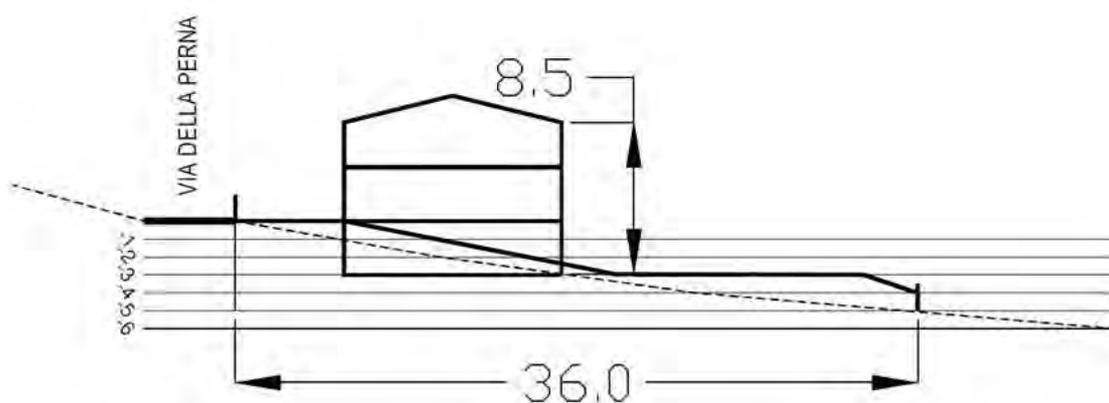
Sezione tipo dell'inserimento di un edificio nell'area edificabile.
